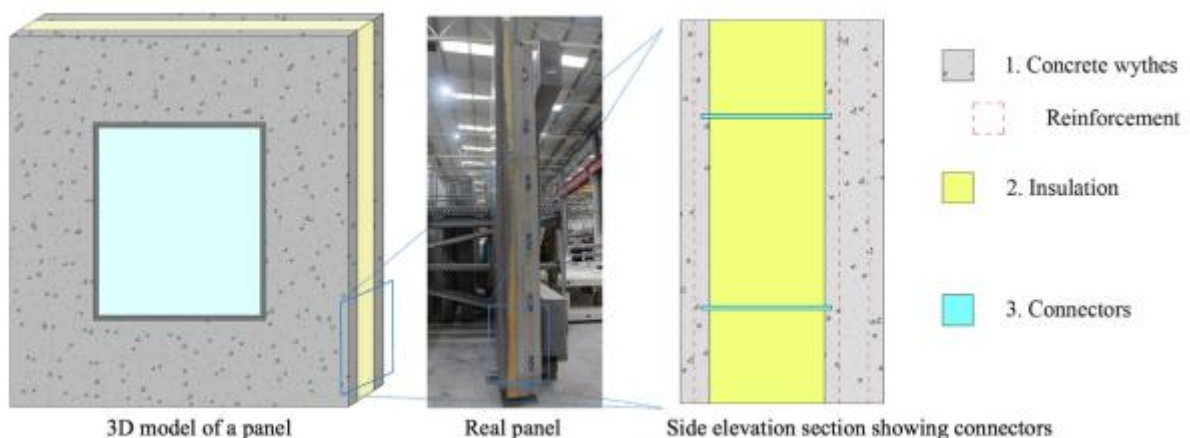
Structure des panneaux sandwich préfabriqué [21]
